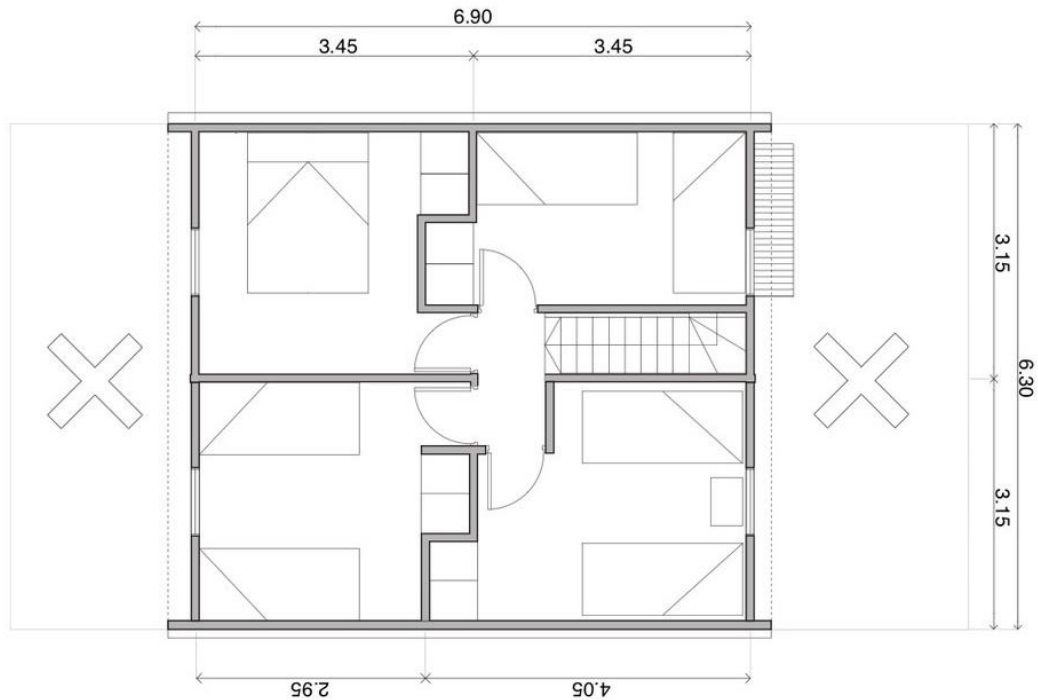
Planta pavimento térreo – sobrado Villa Verde
